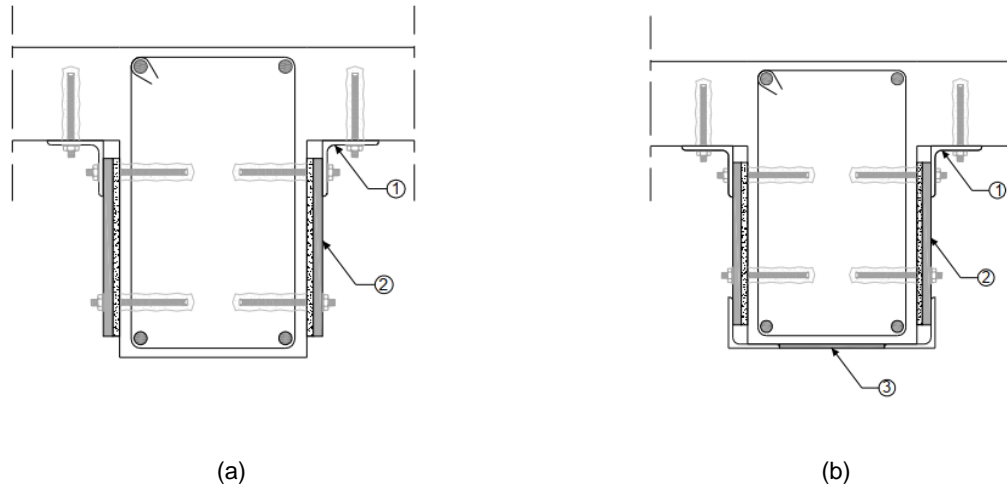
Solução construtiva com recurso a cantoneira fixa à face inferior da laje por intermédio de buchas e chapa metálica, contínua em toda a face da viga (a) e cantoneira fixa à face inferior da laje por intermédio de buchas, ligada ao nível da face inferior da laje por barras metálicas e chapas metálicas descontínuas (b) – adaptado de Sousa (2008)
